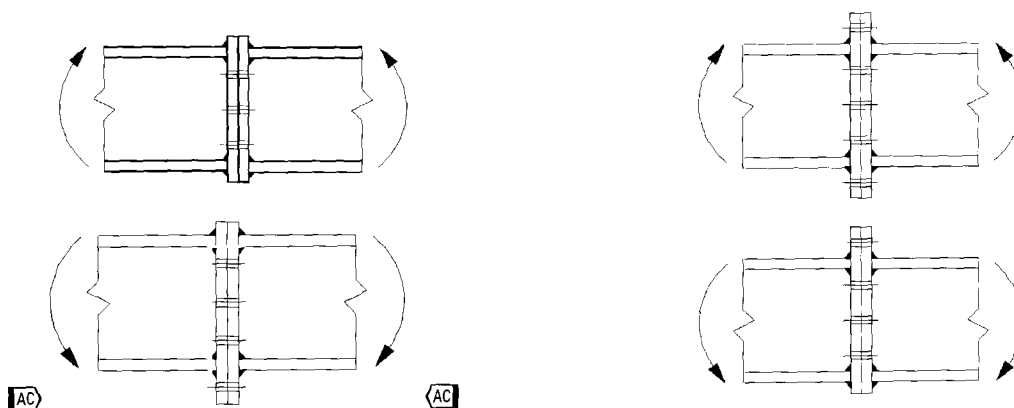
Geschraubte Trägerstöße mit geschweißten Stirnblechen
